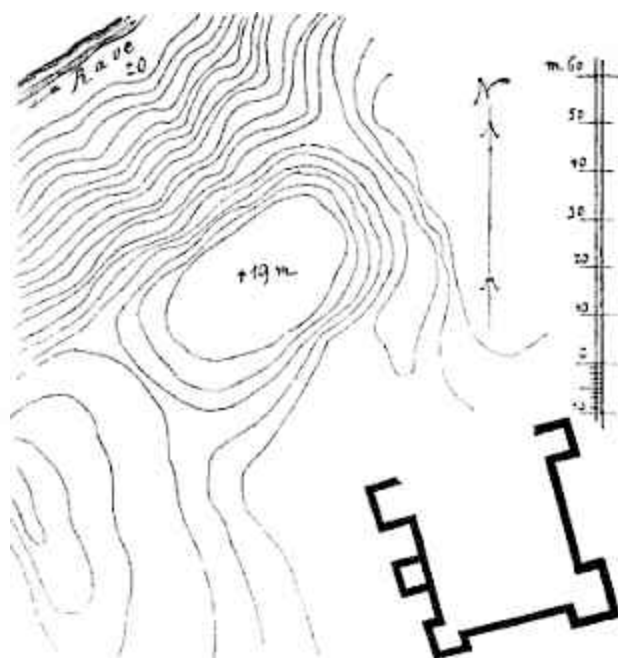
Lageplan des Fiehhause bei Lamgarben.
